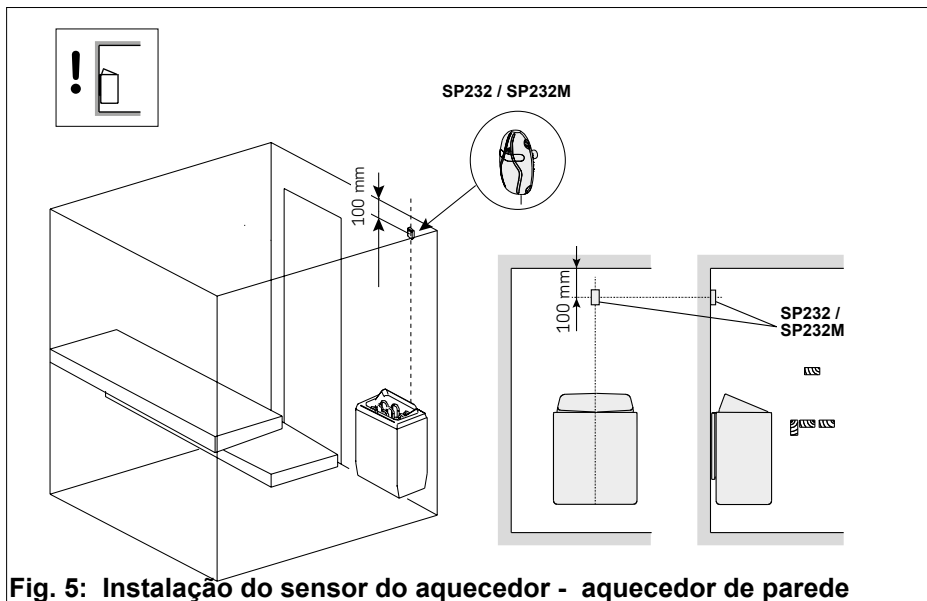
Instalação do sensor do aquecedor - aquecedor de parede
